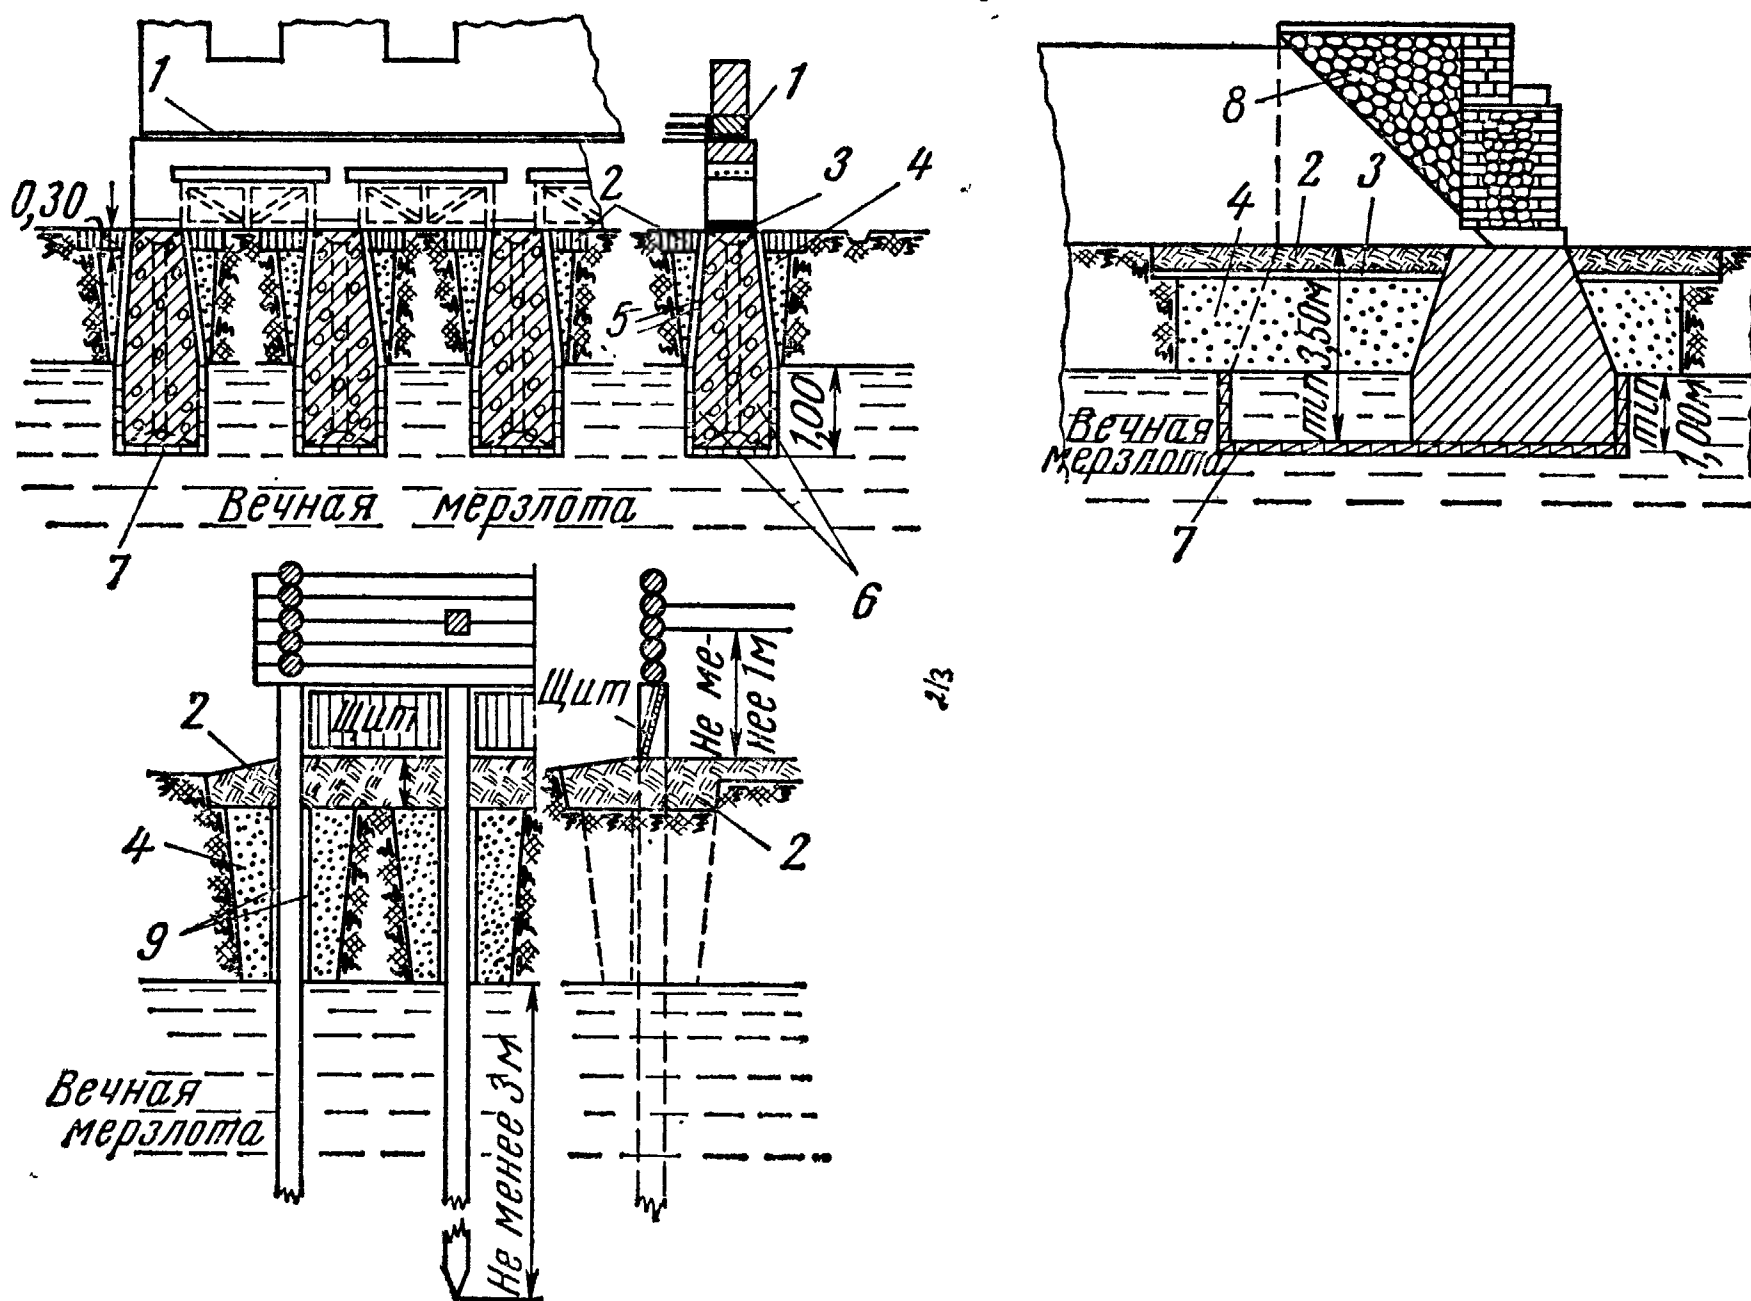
Конструкция фундамента с теплоизоляционными прокладками:
